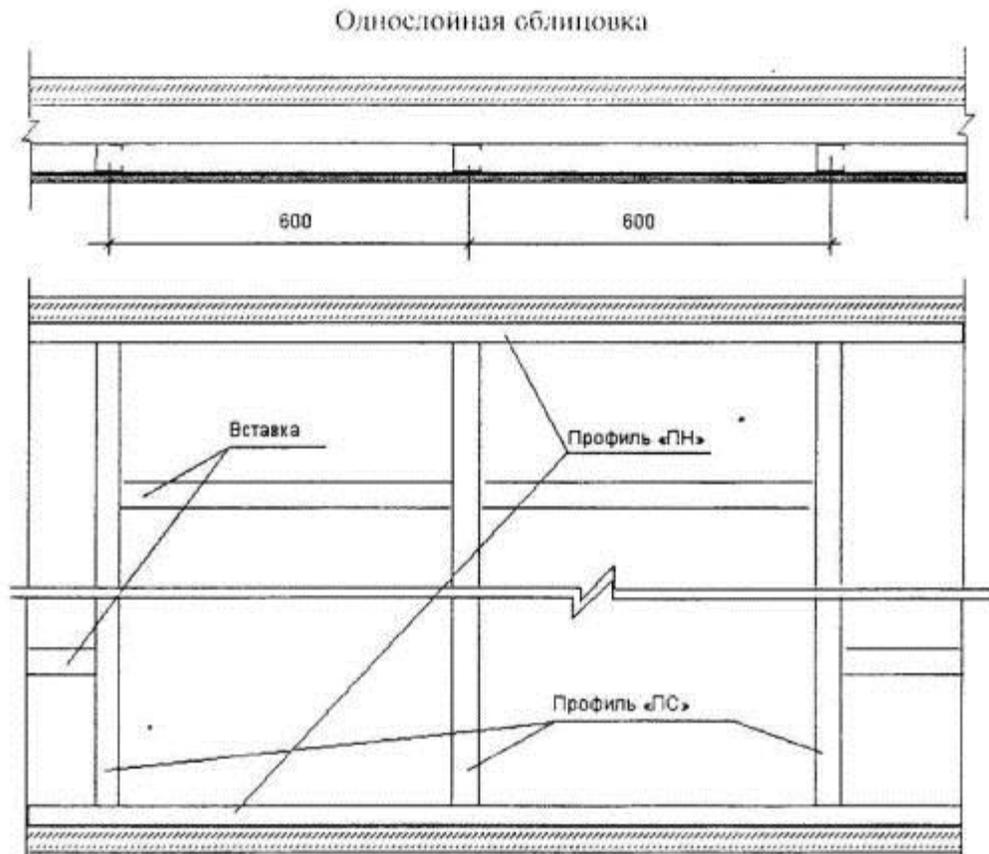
Схема монтажа каркаса в облицовке С 626
